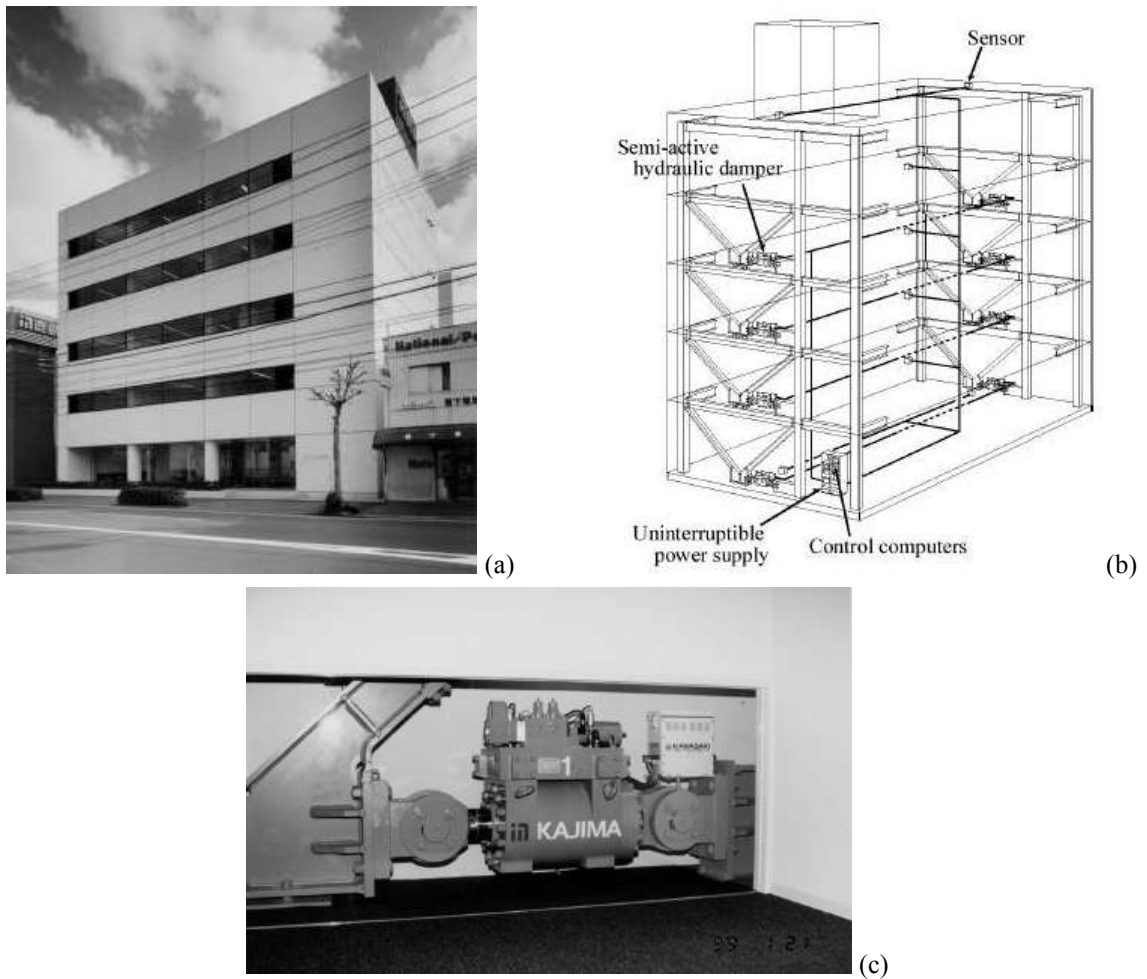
Kajima Shizouka Bldg. (a) vista prospettica; (b) configurazione; (c) SHD.
